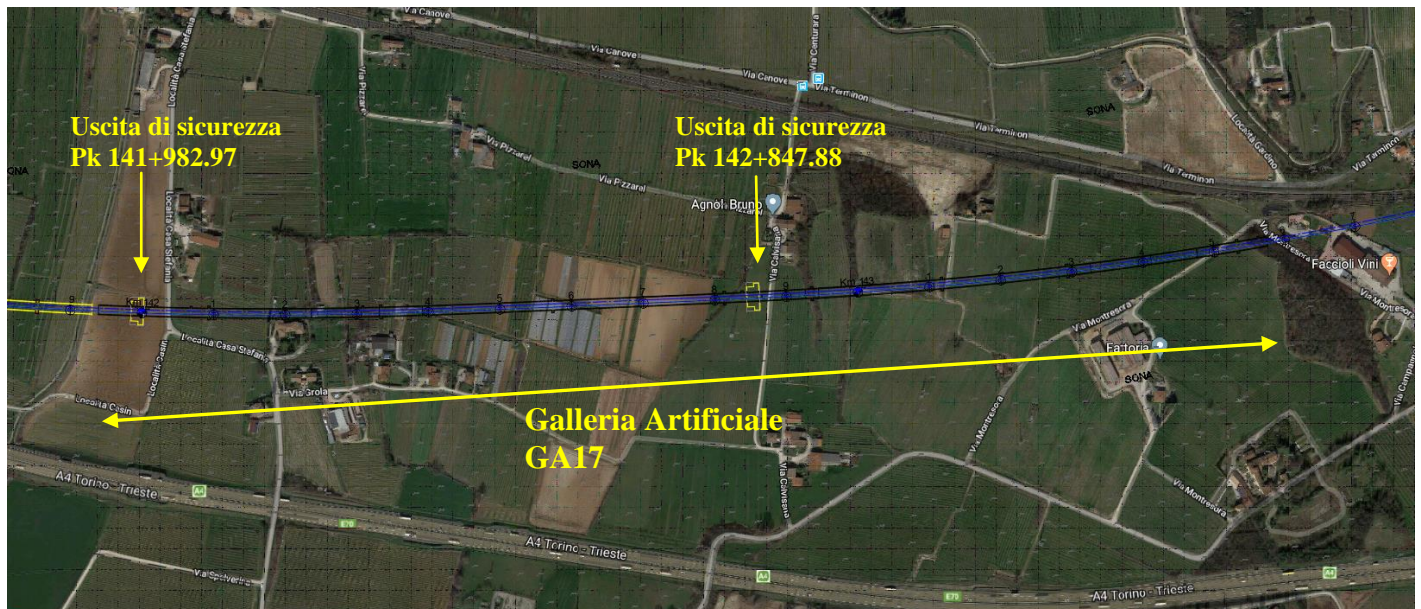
Stralcio planimetrico con ubicazione indicativa delle opere.
